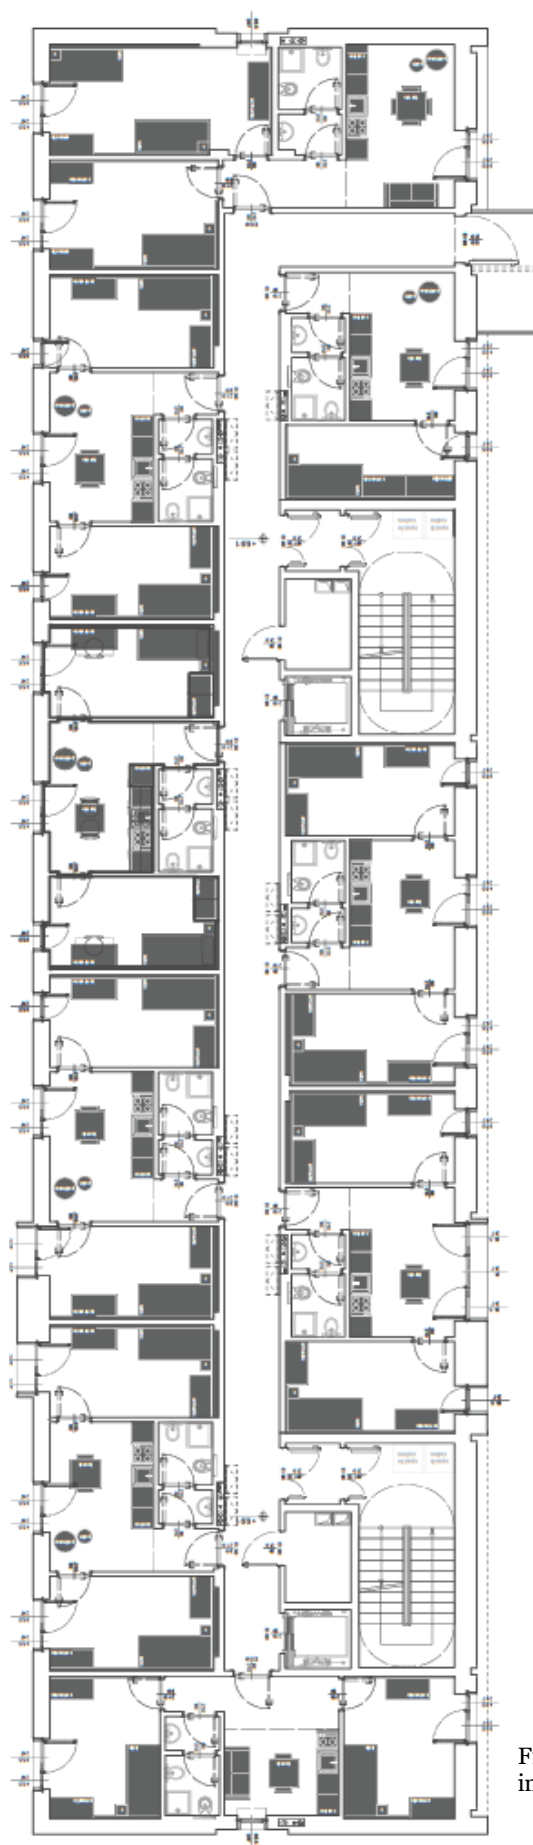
a sinistra: Pianta tipo corpo B, stanze - Fonte: archivio in Domus
